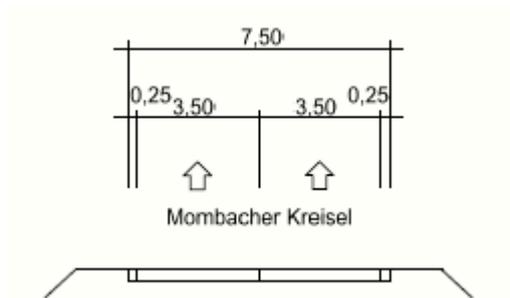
Querschnitt Ausfahrrampe Wiesbaden - Mz-Mombach Erdbau
